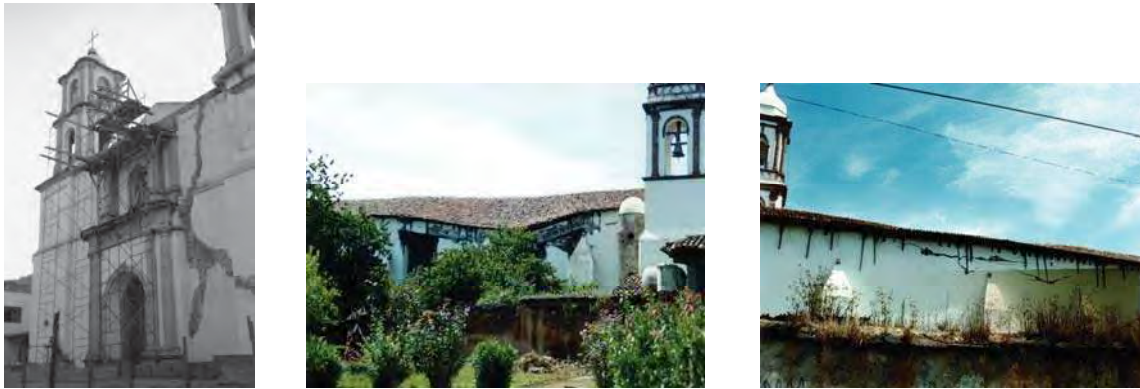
Mecanismo de falla en muros de mampostería no reforzada
